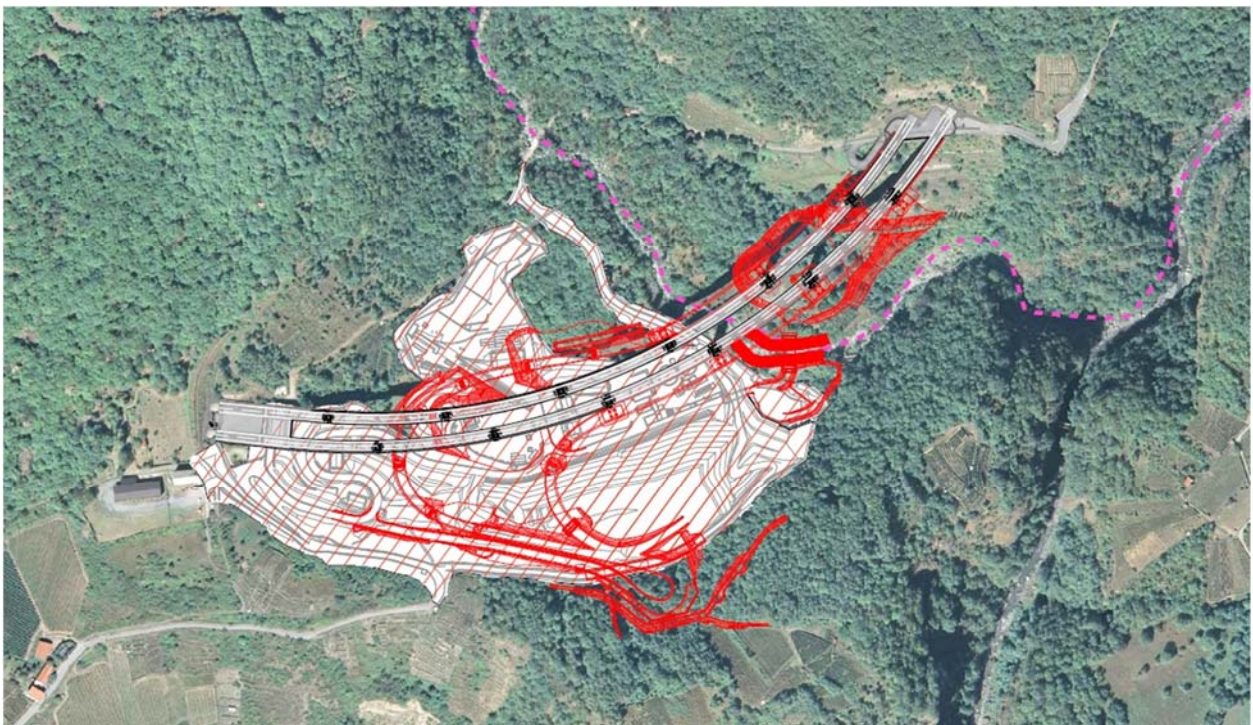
Planimetria progetto Esecutivo (in rosso)
